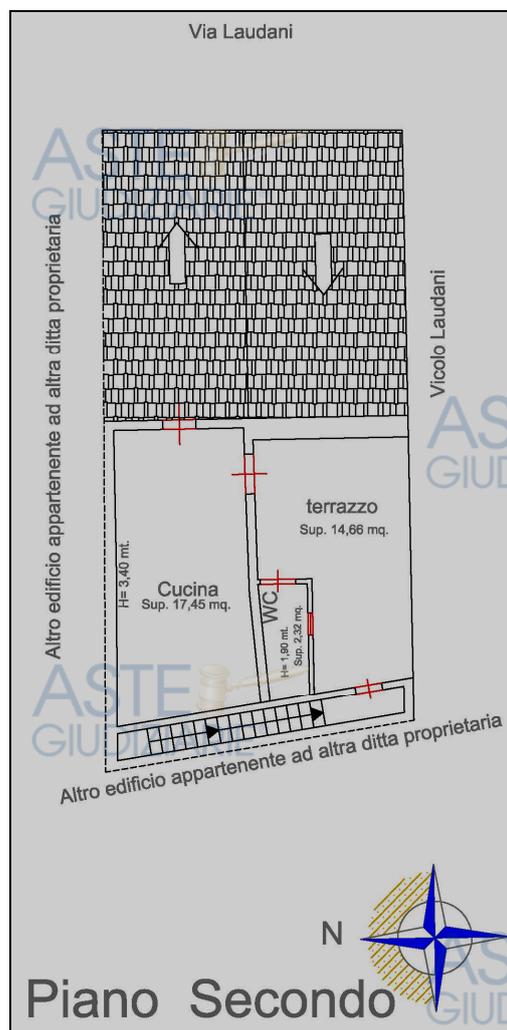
Visualizzazione della planimetria dell'immobile a piano secondo con indicazione delle superfici utili
